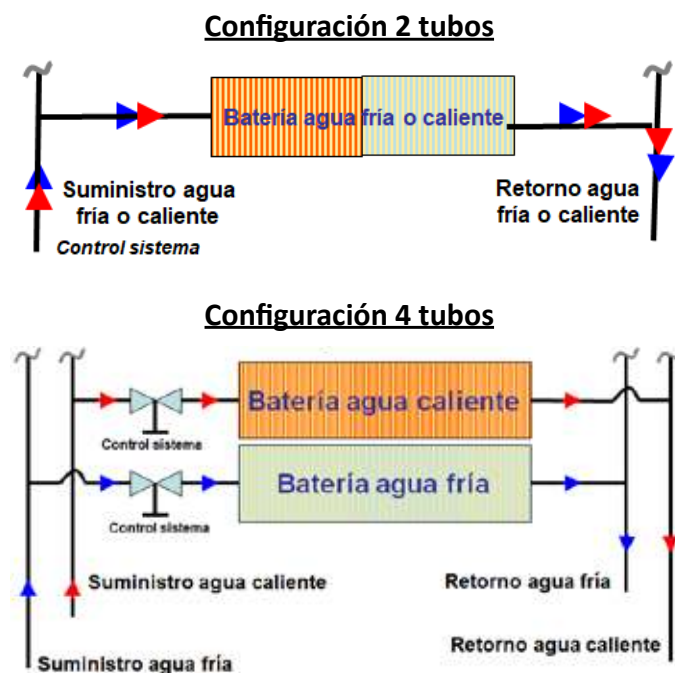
Detalle de conexión de baterías a 2 y 4 tubos.
